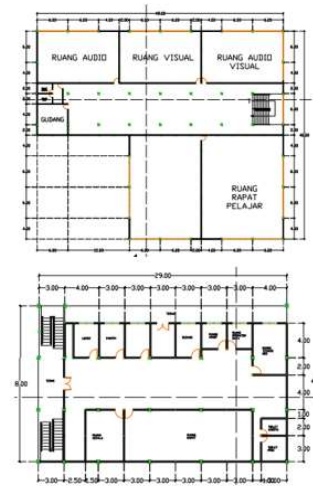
Konfigurasi Massa dan Besaran Massa Bangunan
